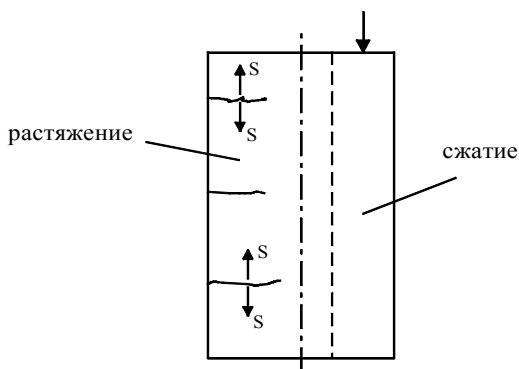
Схемы разрушения кладки при растяжении:
